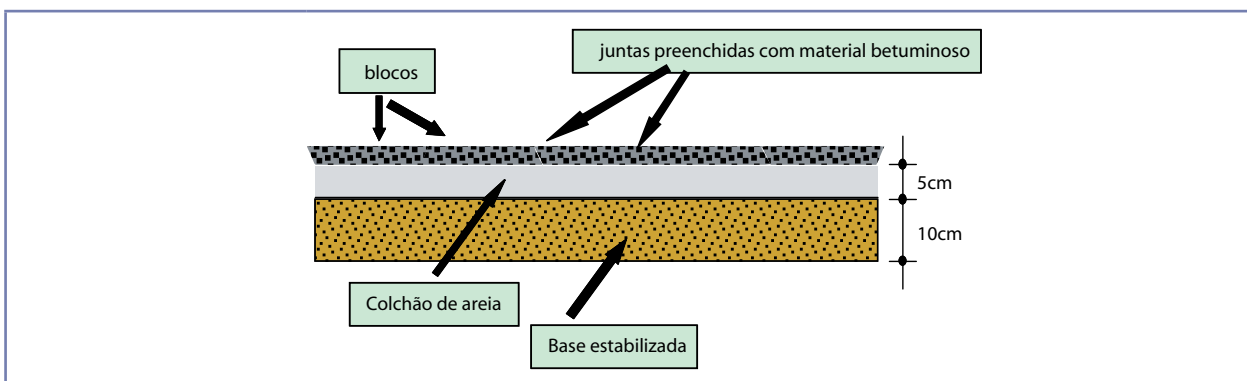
Pavimento em blocos pré-moldados de concreto.
